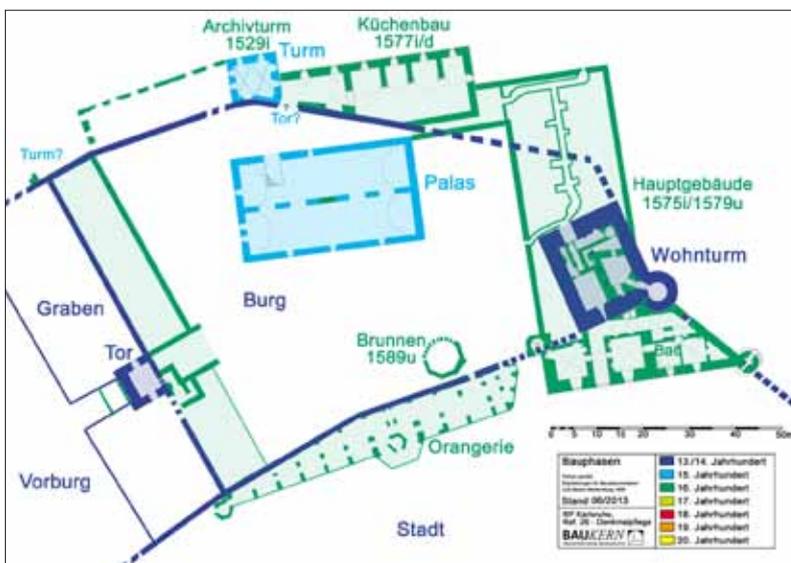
Rekonstruierter Grundriss des „Neuen Schlosses“ im 16. Jahrhundert.
